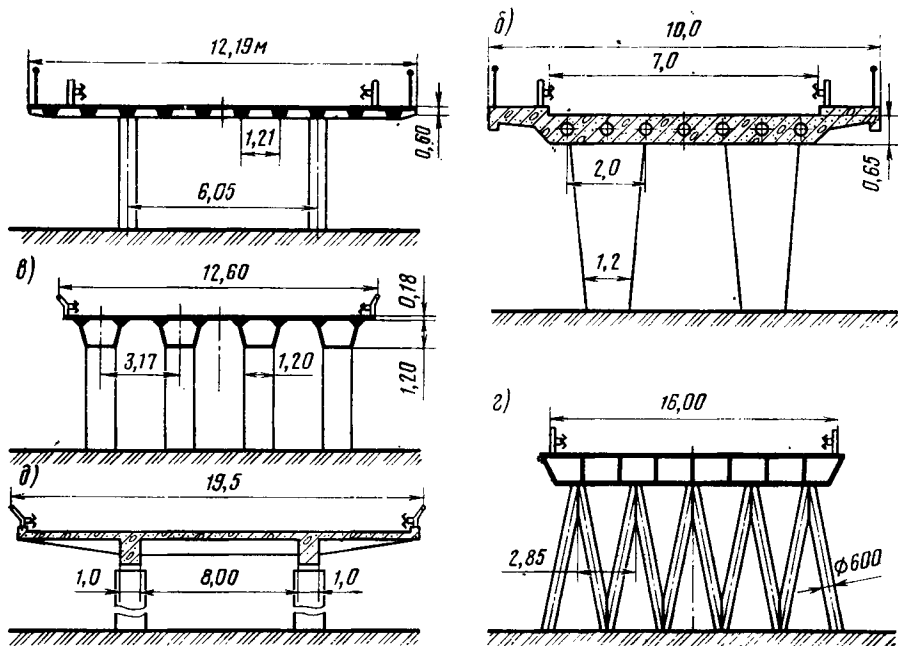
Поперечные сечения железобетонных путепроводов
